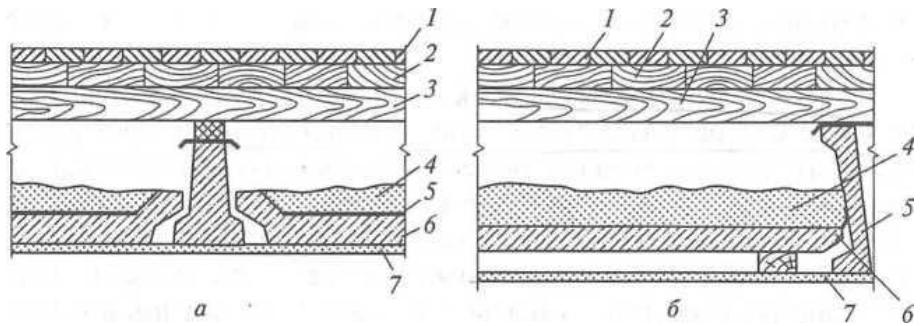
Варианты устройства сборных железобетонных междуэтажных перекрытий балочной конструкции: а — по железобетонным балкам таврового сечения; б — то же, швеллерного сечения; 1 — паркетный пол; 2 — настил из досок $b = 40$ мм; 3 — лаги; 4 — теплозвукоизоляционная засыпка; 5 — пароизоляция; 6 — плиты-вкладыши из легкого бетона; 7 — цементно-песчаная затирка
